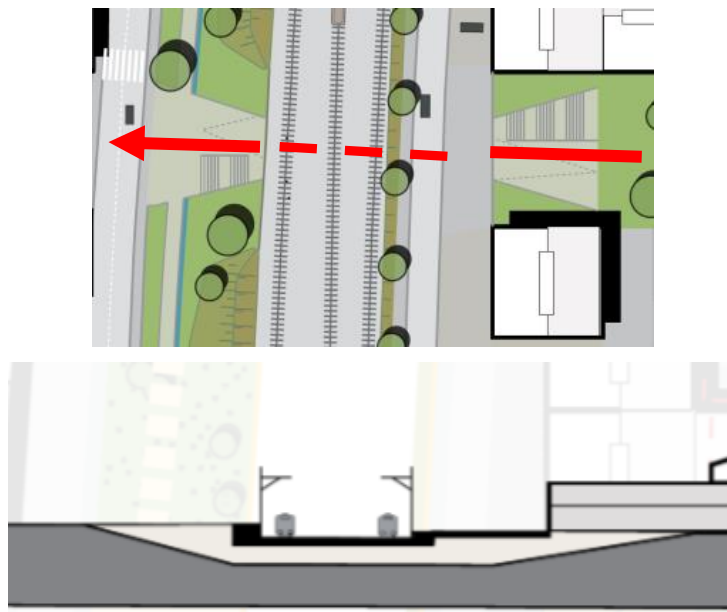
Zoom sur le passage sous voies prévu dans le Schéma Directeur (en plan et en coupe) (MSA 2015)
